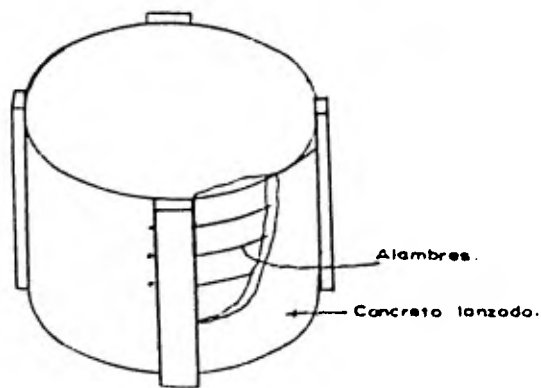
Construcción de tanques de almacenamiento, utilizando concreto lanzado y postentados .
